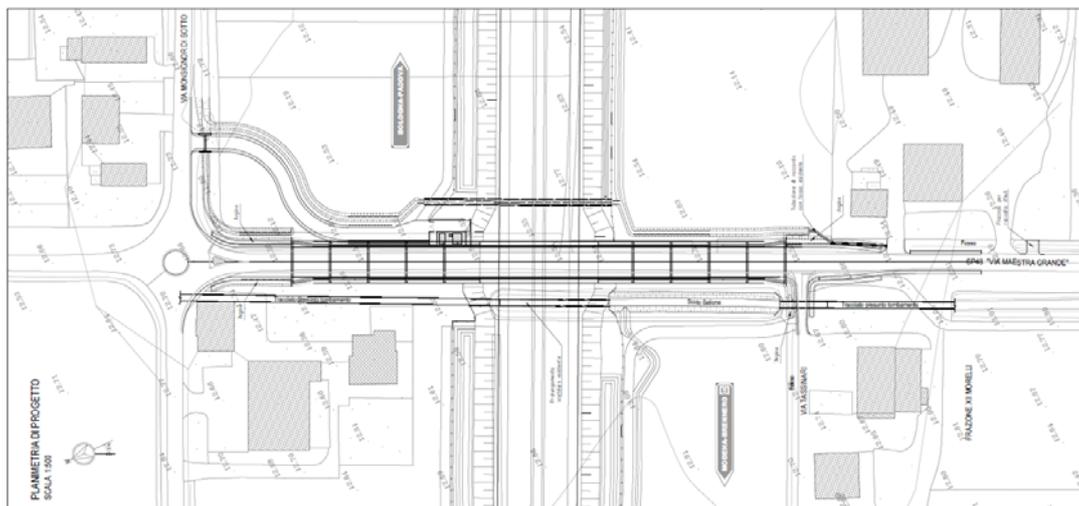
PLANIMETRIA SOTTOPASSO S.P. 43
